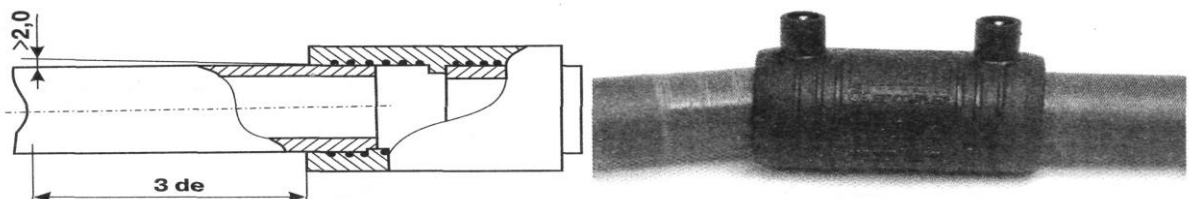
Некачественно выполненное сварное соединение с ЗН (искривление осей трубы и детали)
